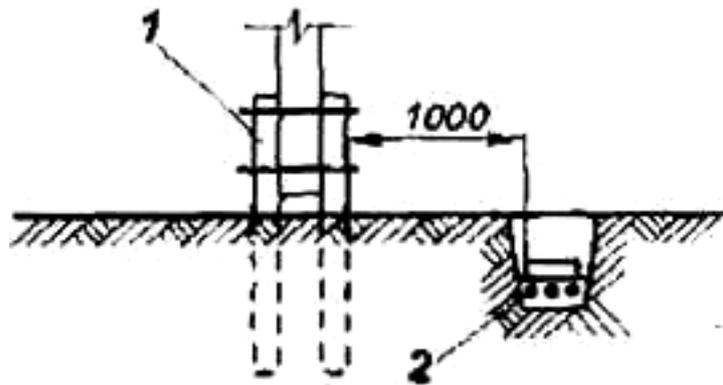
Прокладка кабелей рядом с воздушной линией электропередачи до 1кВ: 1 – опора ВЛ; 2 – кабель 1...10 кВ
